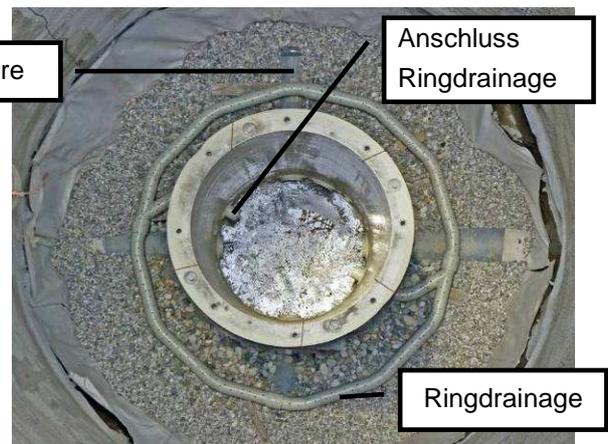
Schachtneubau mit Ringdrainage und kornabgestufter Kiesverfüllung
